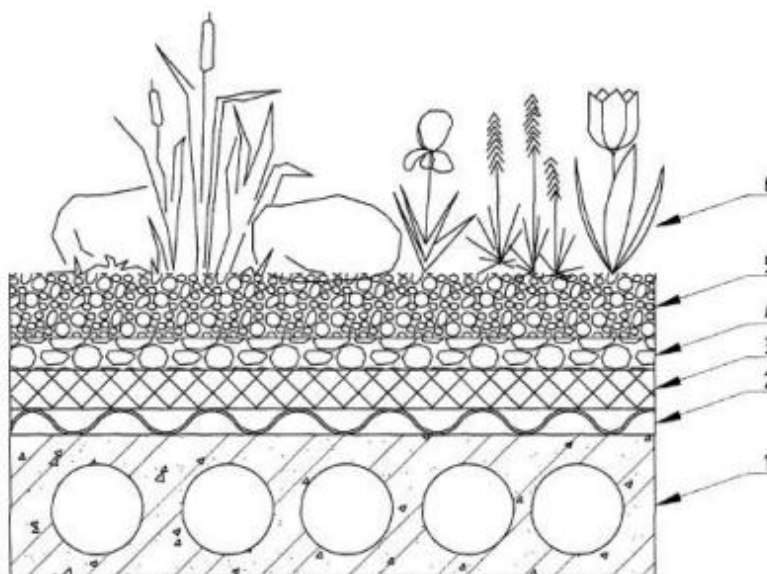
Состав «зеленой» кровли для жилых зданий:
